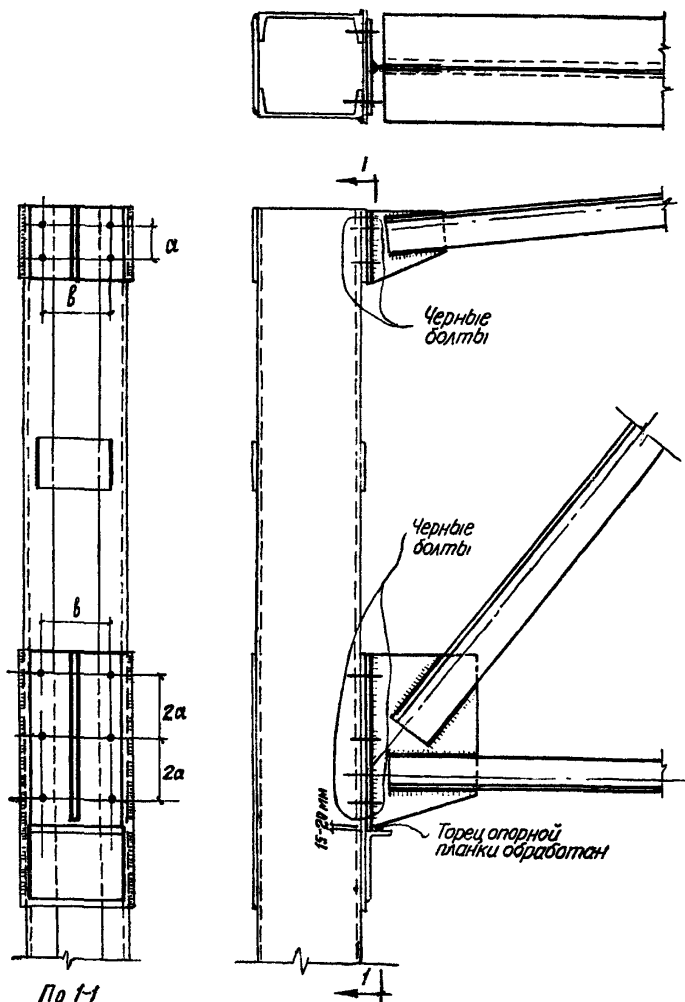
Крепление стропильной фермы к колонне, состоящей из двух ветвей соединенных плавками
